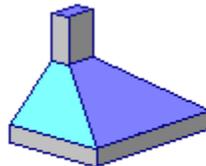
Zapata Aislada, Concreto, Cuadrada, Sección Variable, Colindante
